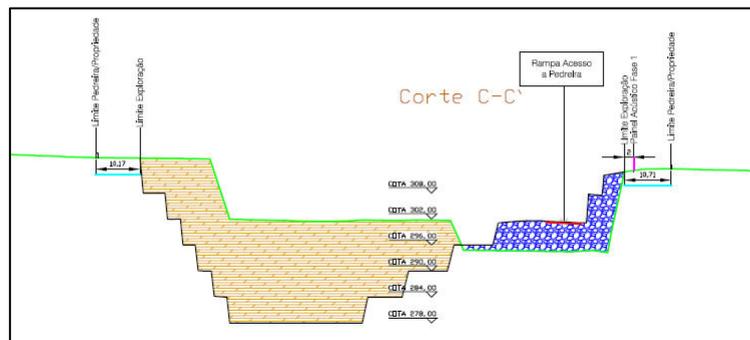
Perfil de exploração - Corte C-C' - com a localização da barreira acústica (Fonte: Elementos Complementares, março de 2022)
